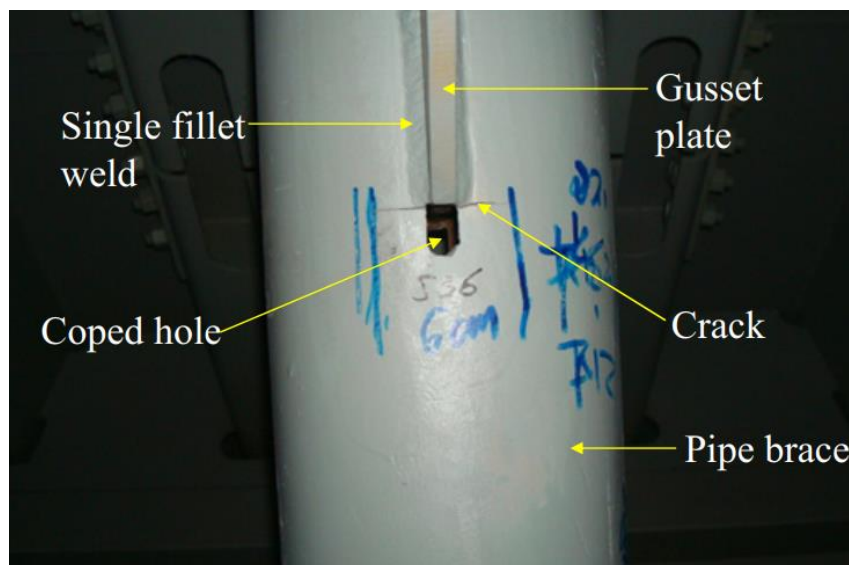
Grietas observadas en el campo en los diafragmas longitudinales de las vigas cajón: grieta menor a media (RCB)
